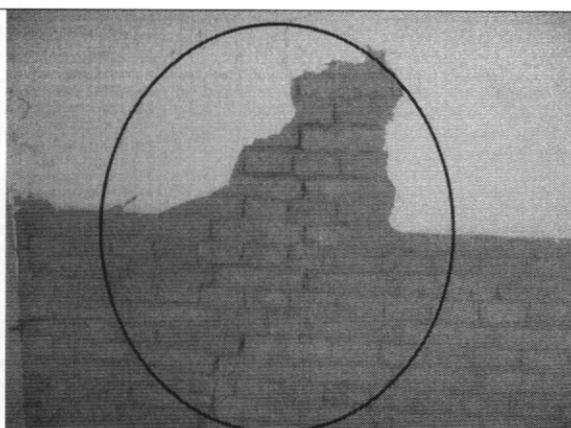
Agrietamiento diagonal en muro de carga
